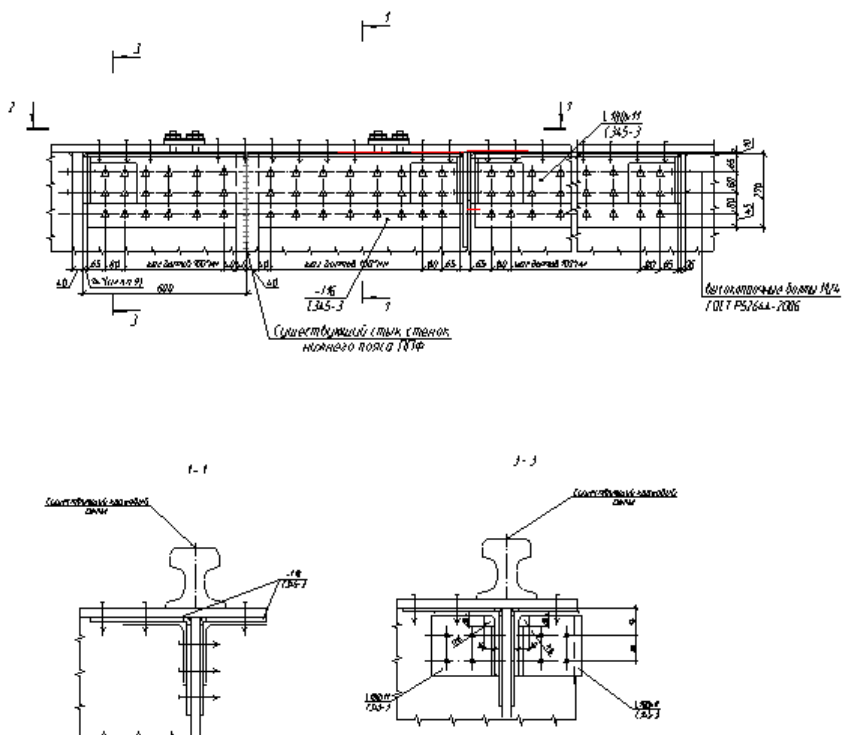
Усиление зоны сопряжения стенки с верхней полкой нижнего пояса подкраново-подстропильной фермы на высокопрочных болтах
